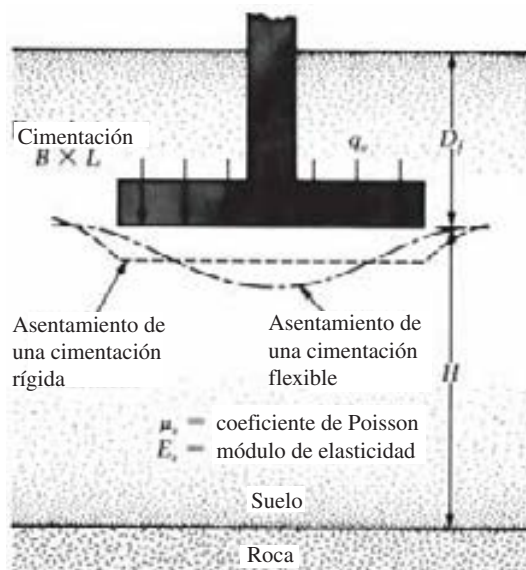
Asentamiento elástico de cimentaciones flexibles y rígidas
